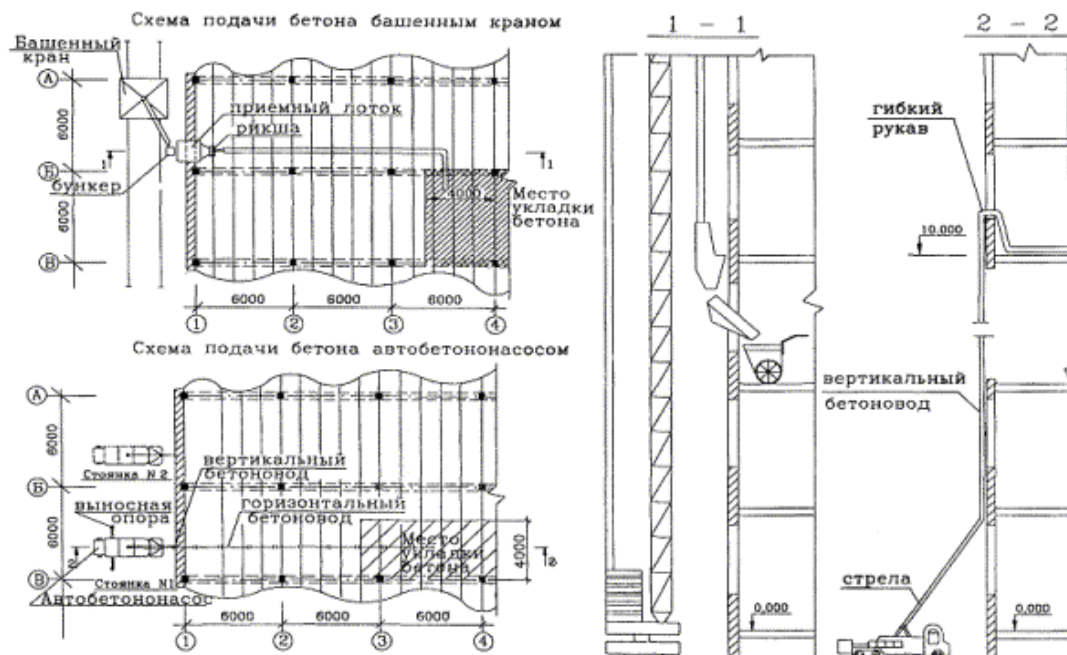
Схема подачи бетона за допомогою крану та автобетононасосу
